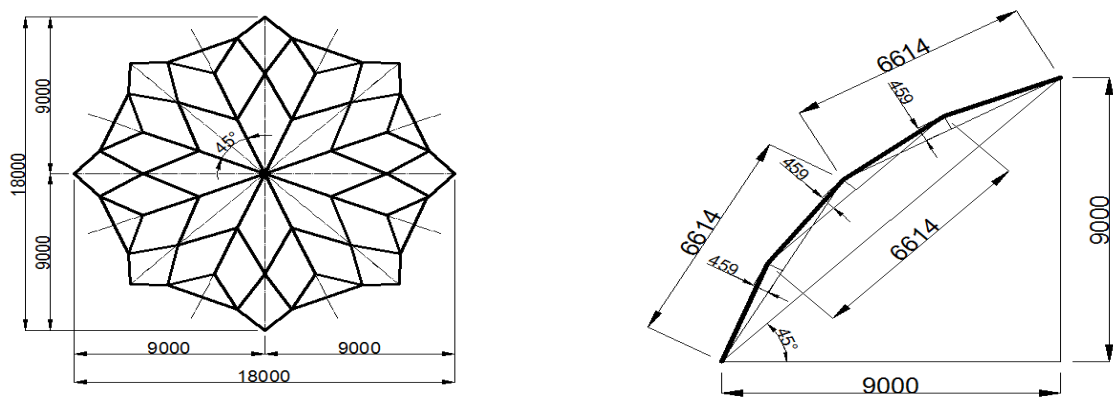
Геометрические параметры покрытия здания (поперечный разрез и план покрытия)
